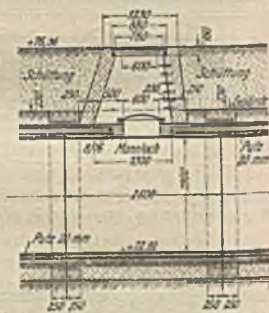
r. Mannloch mit Schacht der Eisenbetondruckrohrleitung des Glambockwerkes.
